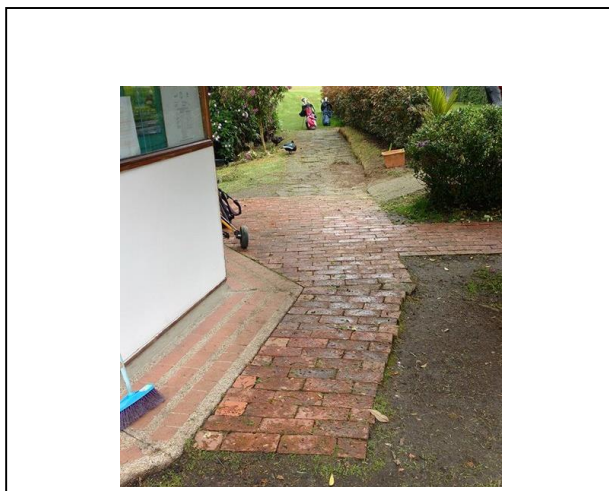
Tramo a intervenir para instalación de prefabricados en caucho
